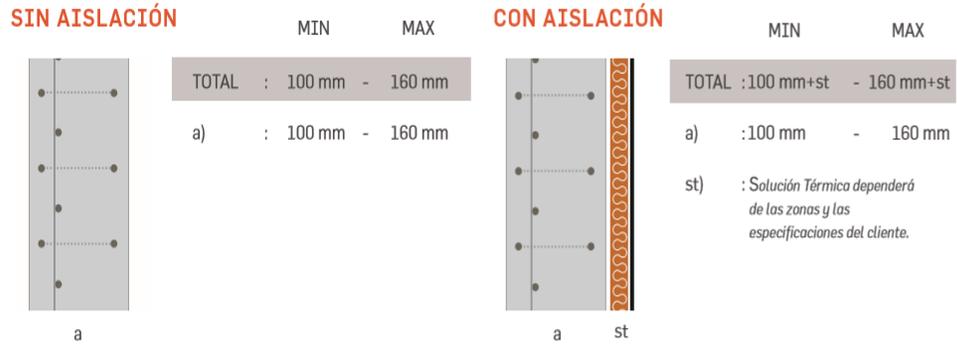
Grosor Muros Fuente: Baumax
